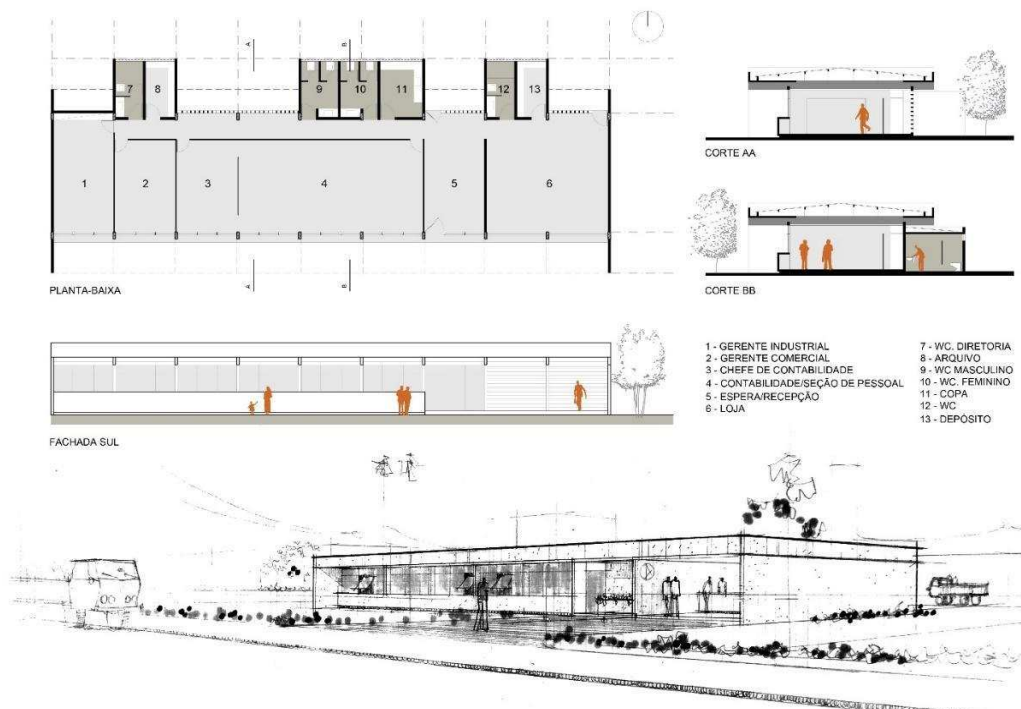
Planta baixa dos volumes/ Metalúrgica Santa Cruz. Igarassu. PE
